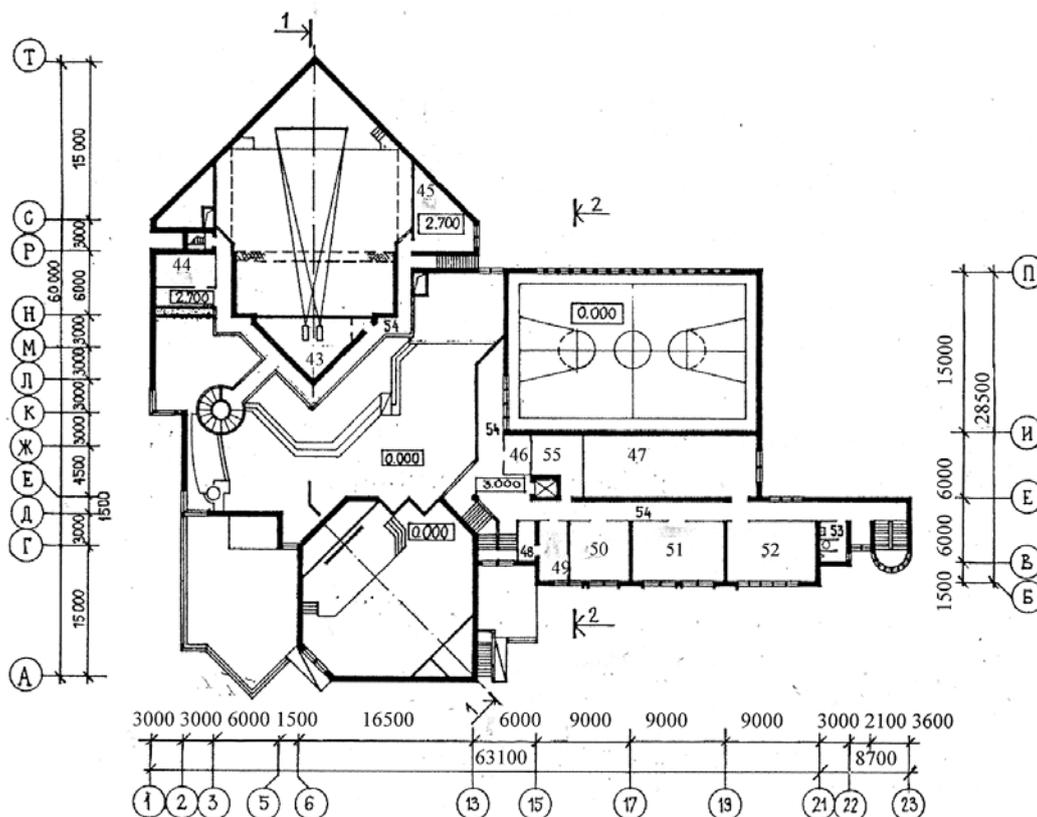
План второго этажа клубного здания досугового типа на 750 посетителей: 43 – кино и светопроjectionная; 44 – вентиляционная камера; 45 – методический кабинет; 46 – радиоузел; 47 – прокат клубного инвентаря; 48 – кладовая музыкальных инструментов; 49 – комната музыкантов; 50 – игротека на 10 человек; 51 – кружковая технического творчества; 52 – художественная студия; 53 – санитарные узлы; 54 коридор и галереи; 55 – вентиляционная камера
